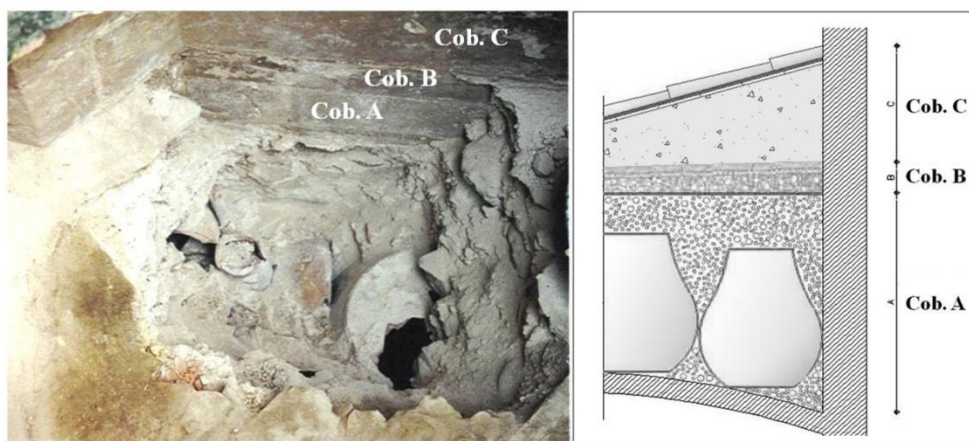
Cata de la cubierta de la Catedral de Tortosa (1996). Estratos constructivos.
